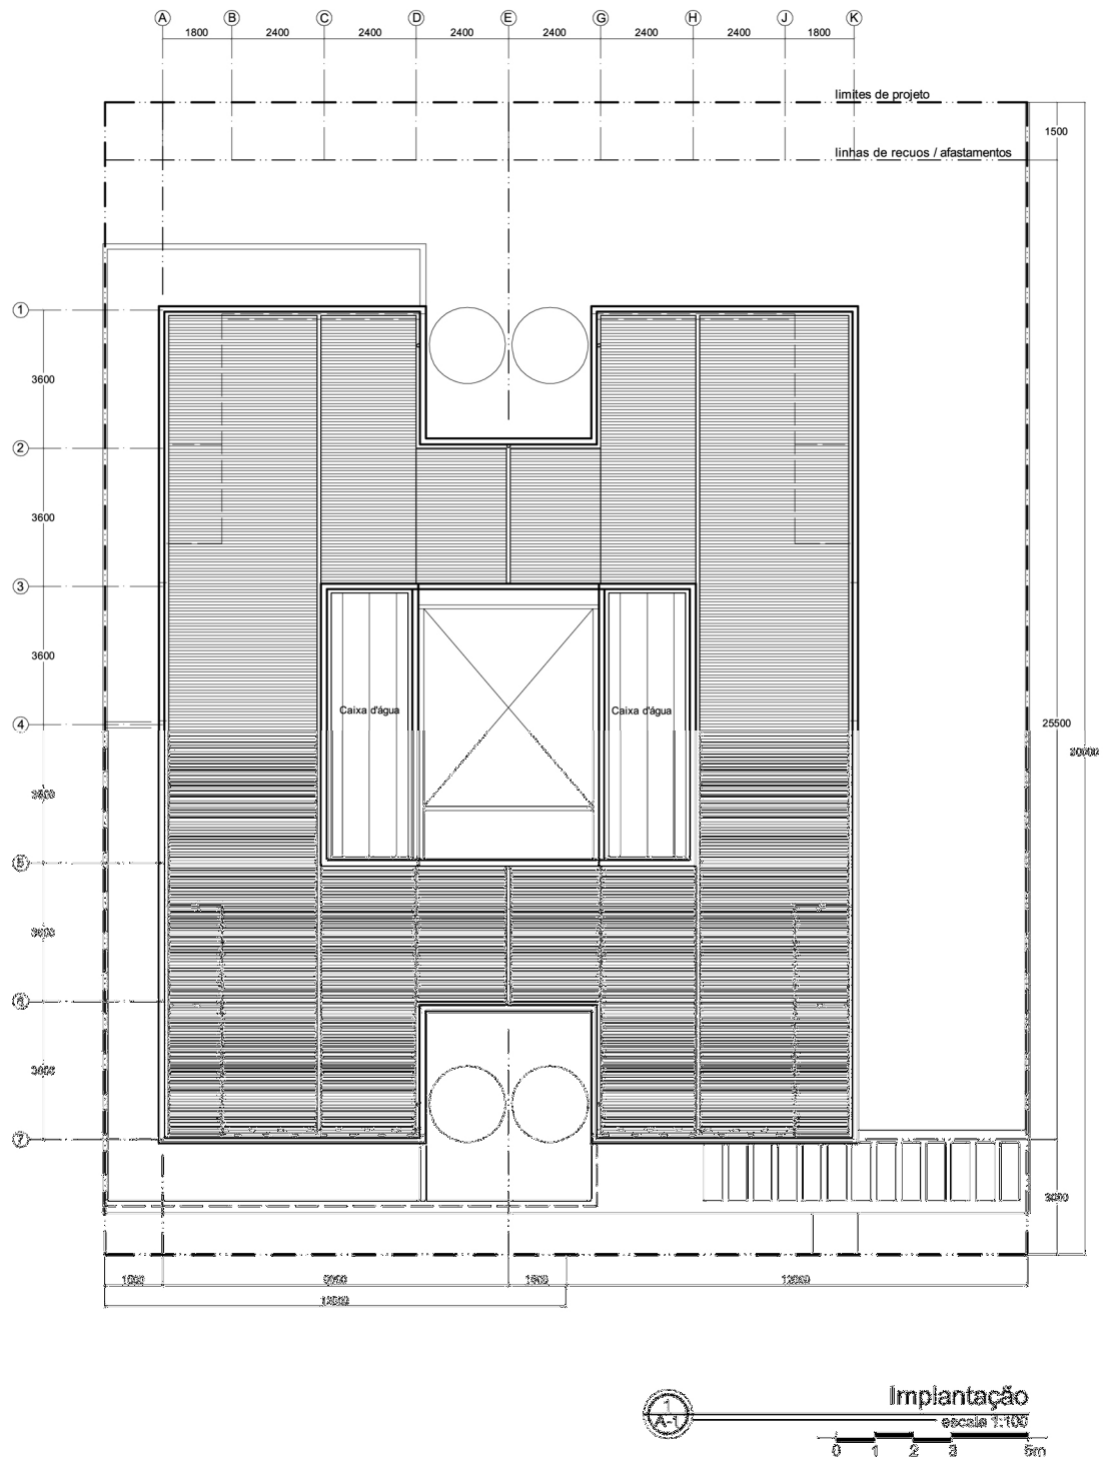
Planta de Implantação. Fonte: Arquivo do autor
